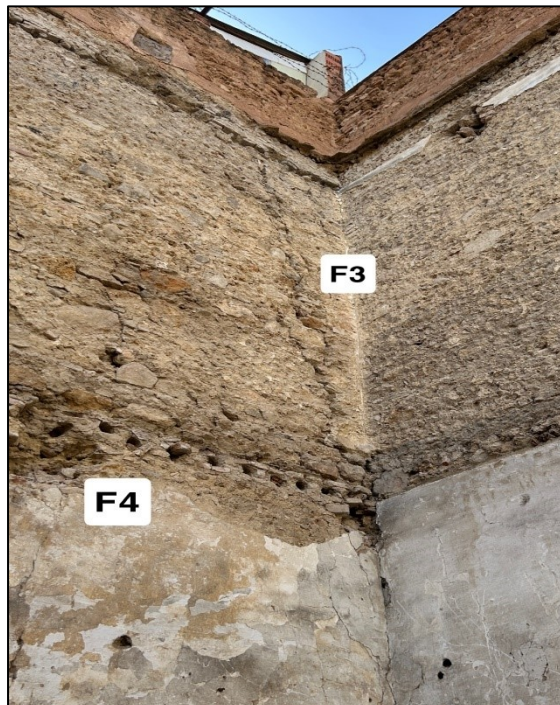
Fissuration à l'angle d'un mur porteur en pierre
